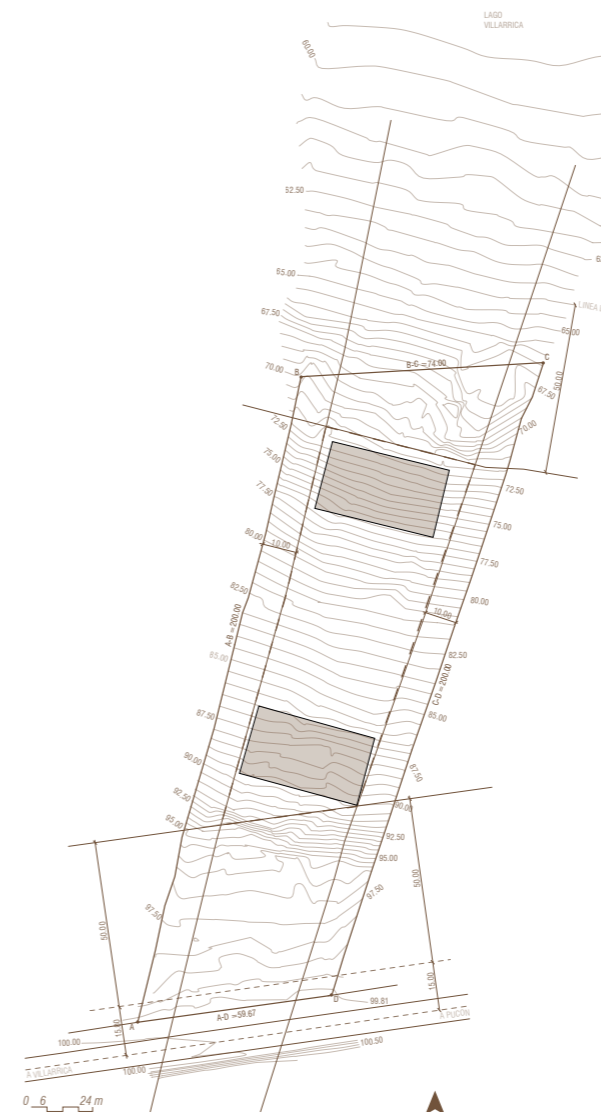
Planta Decisión Arquitectónica Rakün Villarrica. Elaboración propia.
